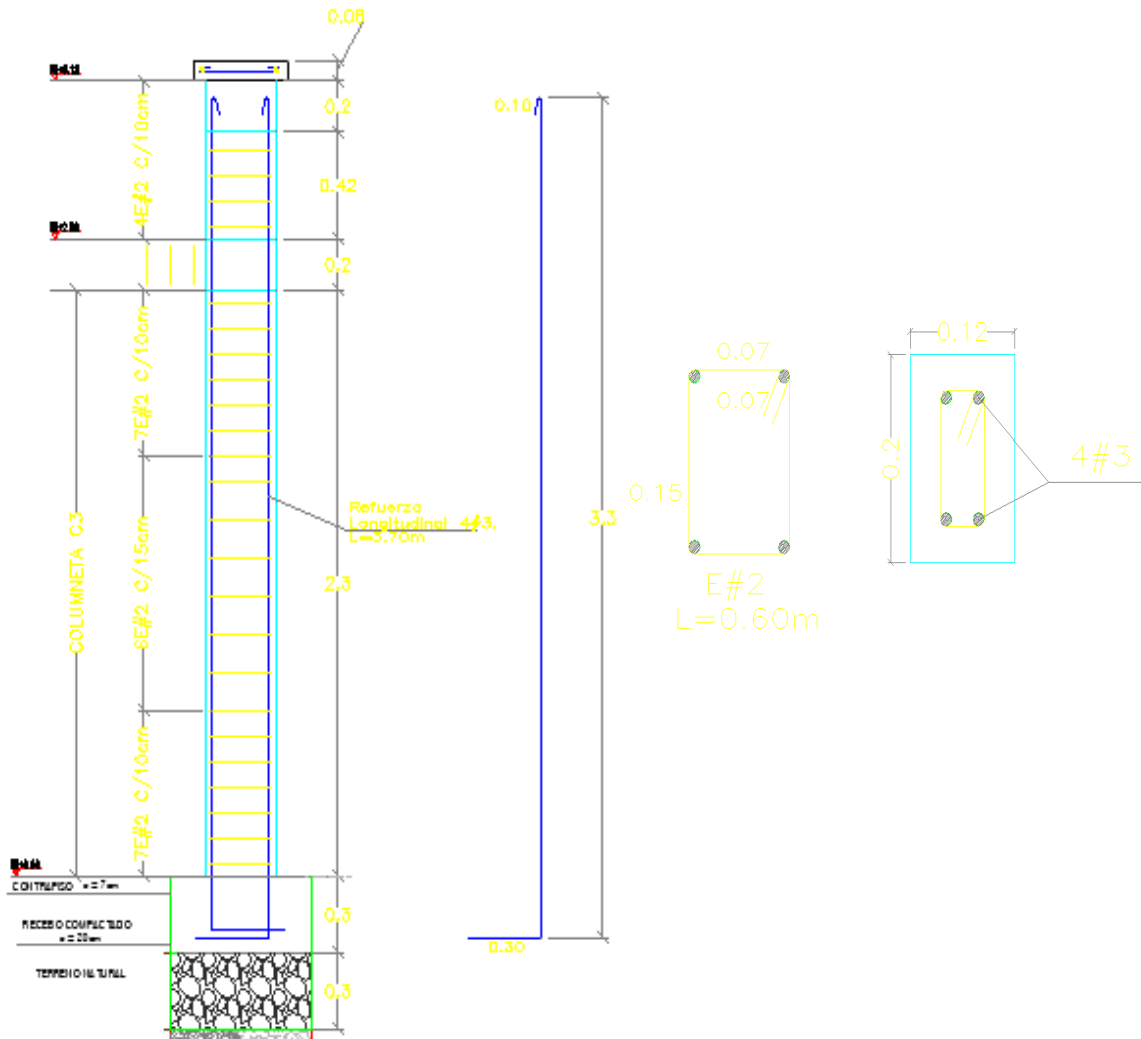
Columnetas tipo 3 AUTOCAD.
